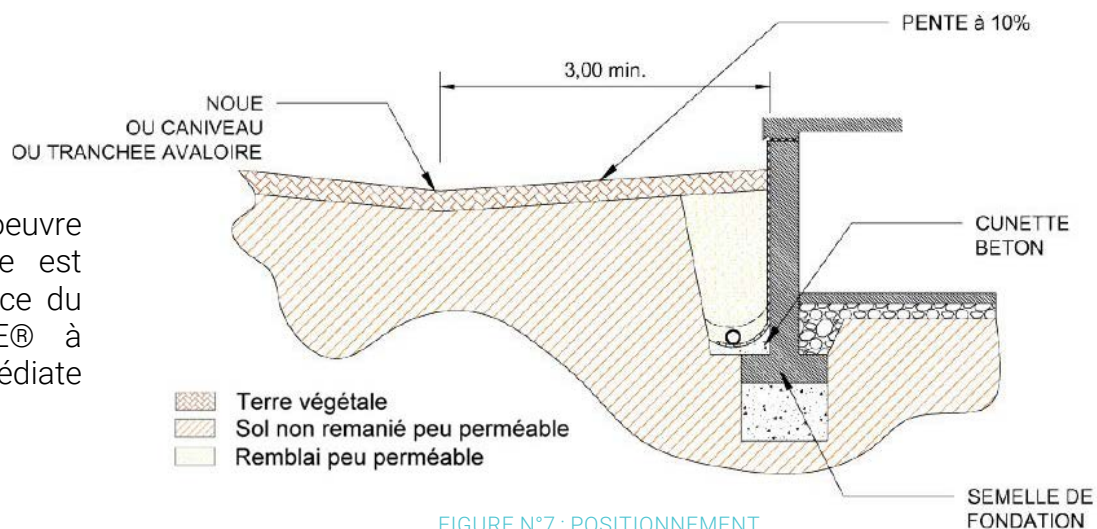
POSITIONNEMENT AU PIED DES FONDATIONS
